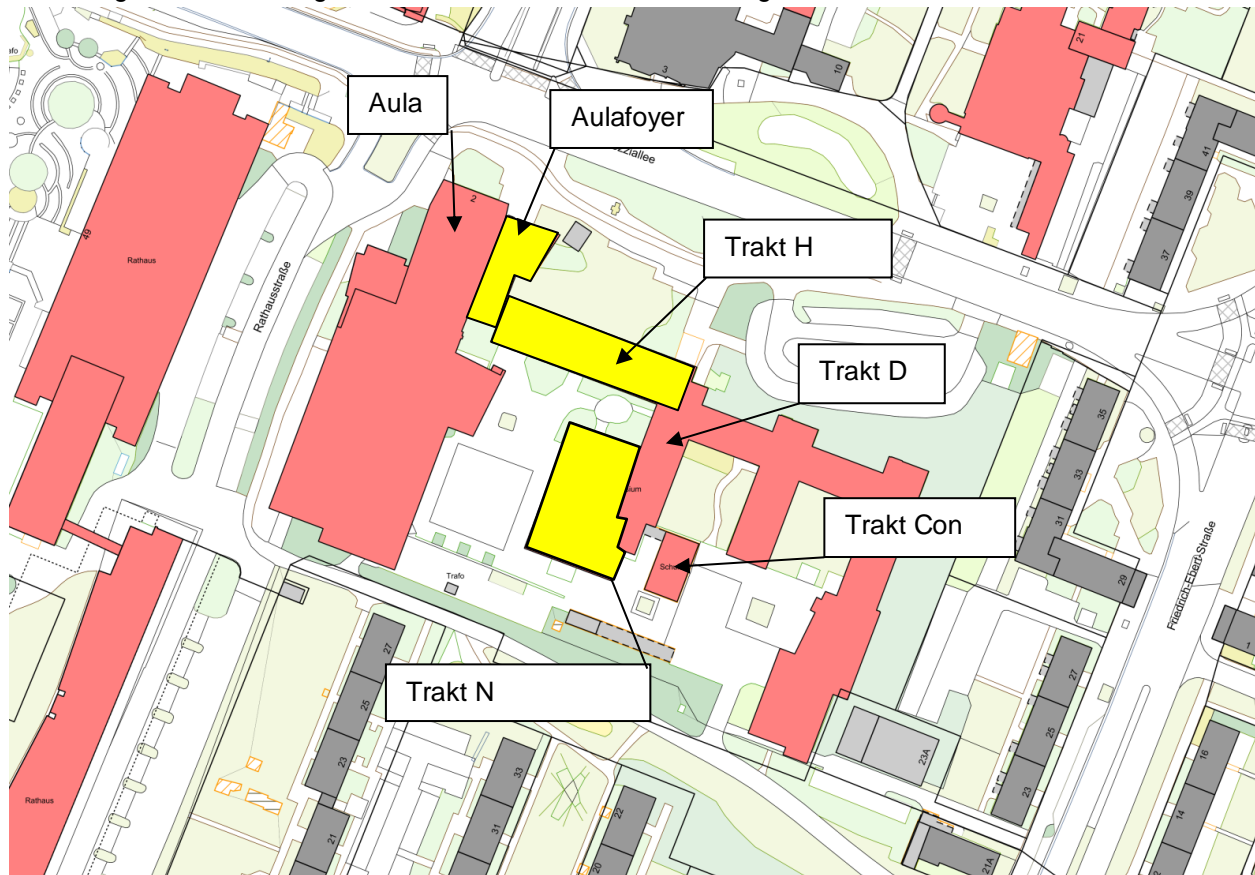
Lageplan Ratsgymnasium von 2014 mit Markierung der abzubrechenden Gebäude
